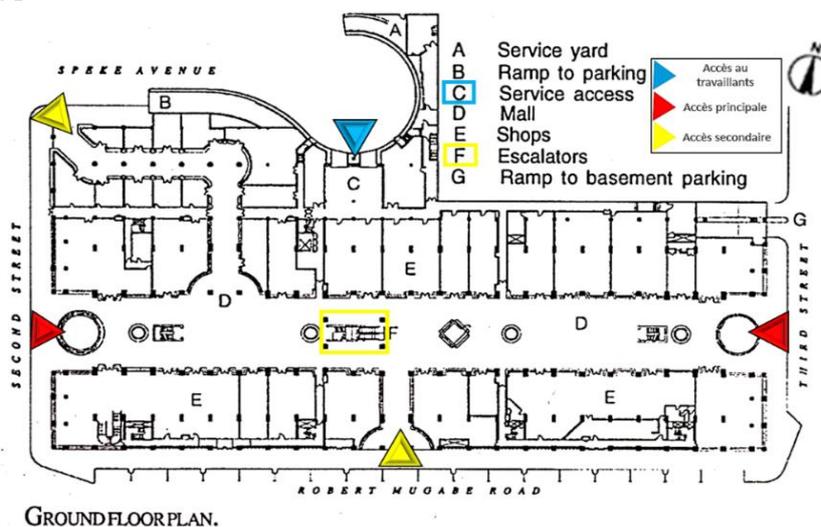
plan du rez-de-chaussée. (Source : archnet.org (traité par l'auteur))
